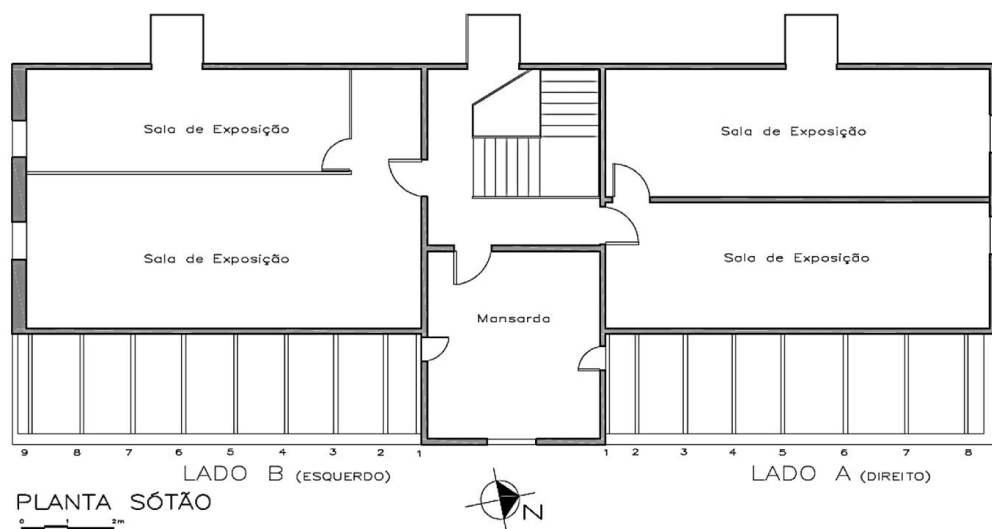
PLANTA DO SÓTÃO DA CASA DA CULTURA.
